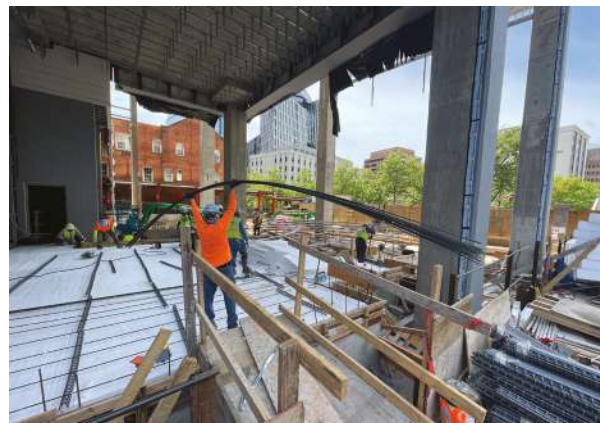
Instalación de refuerzo BFRP No. 3 para uno de los firmes de concreto
